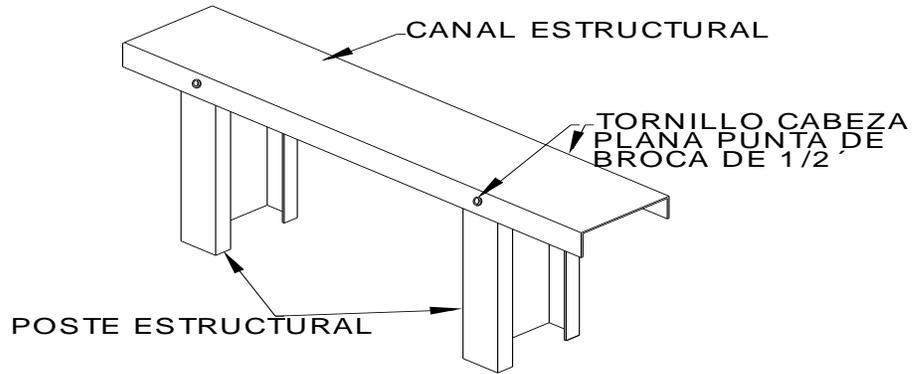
Detalle 1 de unión de perfil canal y paral
